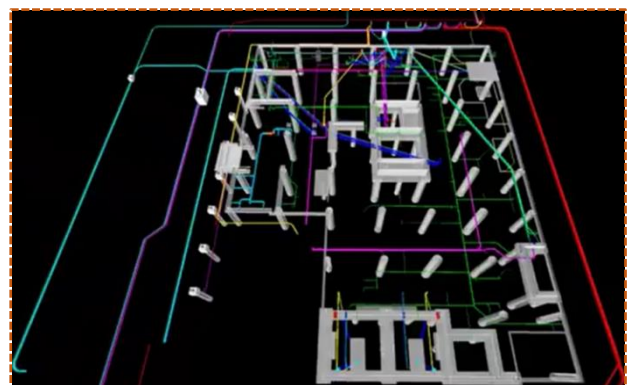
Le système poteaux-poutres. [Source : <https://www.youtube.com>]
